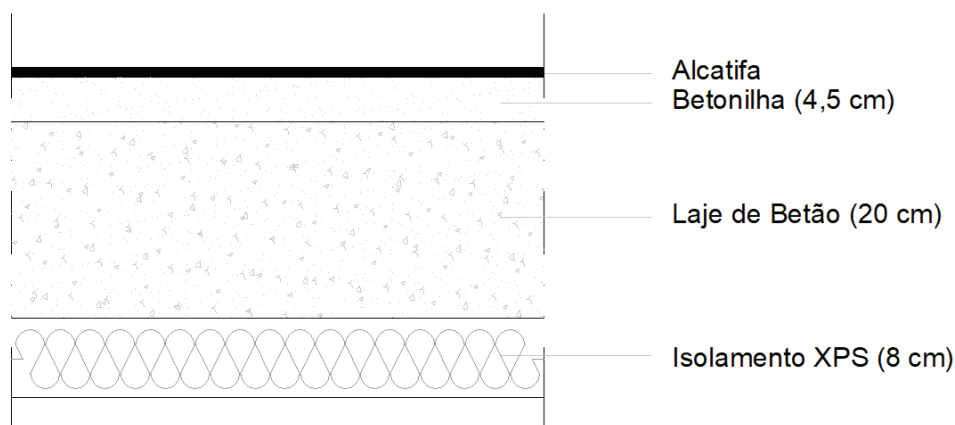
Pormenor construtivo do pavimento interior tipo VI (cota 13.62-Mid ATL e the coast)
